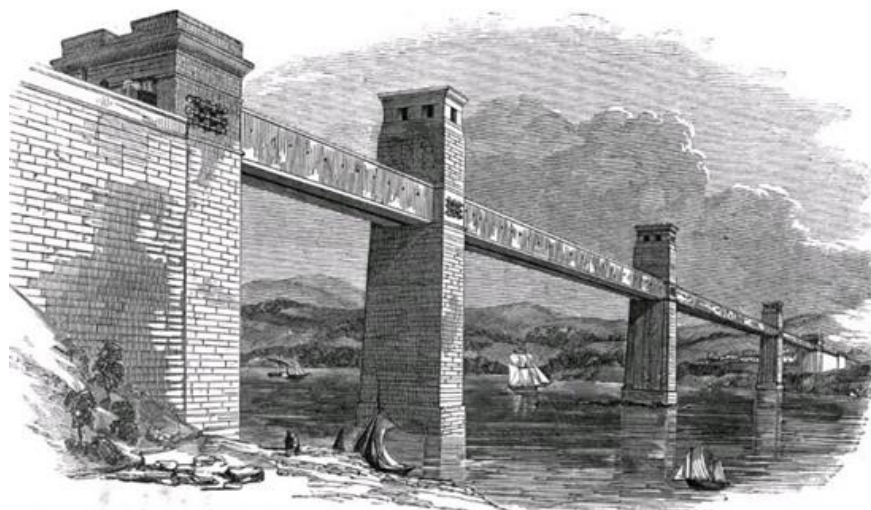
Ponte Britannia, construída com perfil em caixão metálico (Robert Stephenson, 1850)
